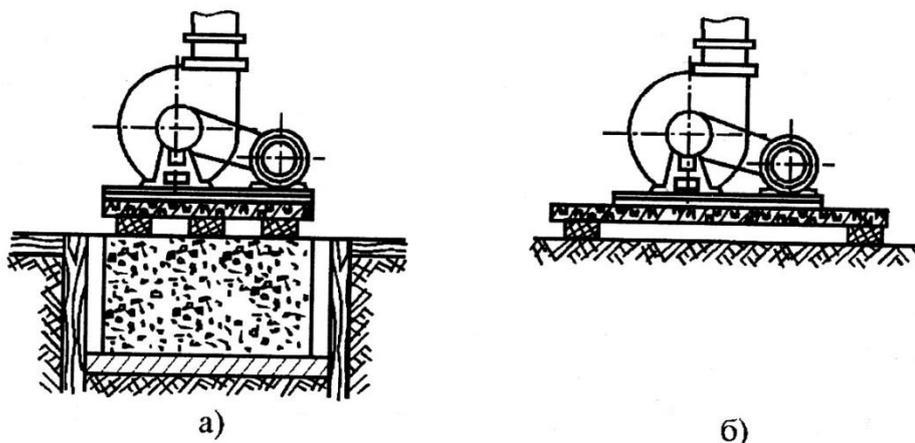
Установка агрегатов на виброгасящем оборудовании:
